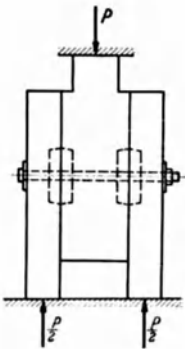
Probekrper zu Druckversuchen mit Holzverbindungen.
